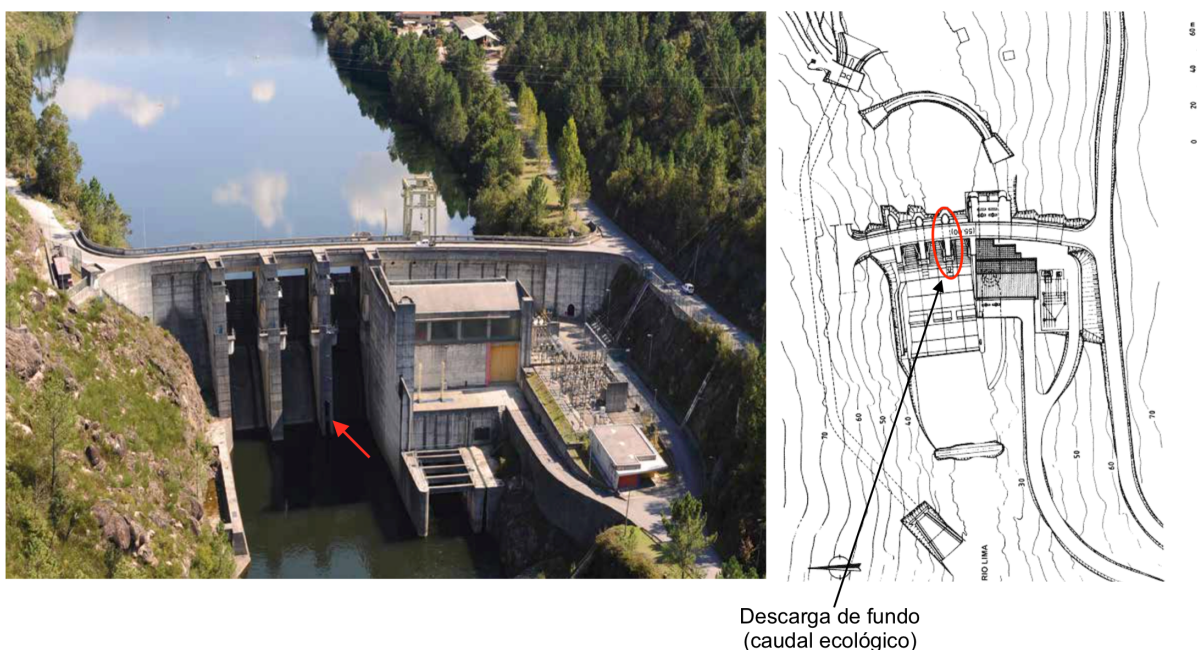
Barragem do Touvedo. Planta. Adaptado de (EDP, 2013). (cnpqb.apambiente.pt).
